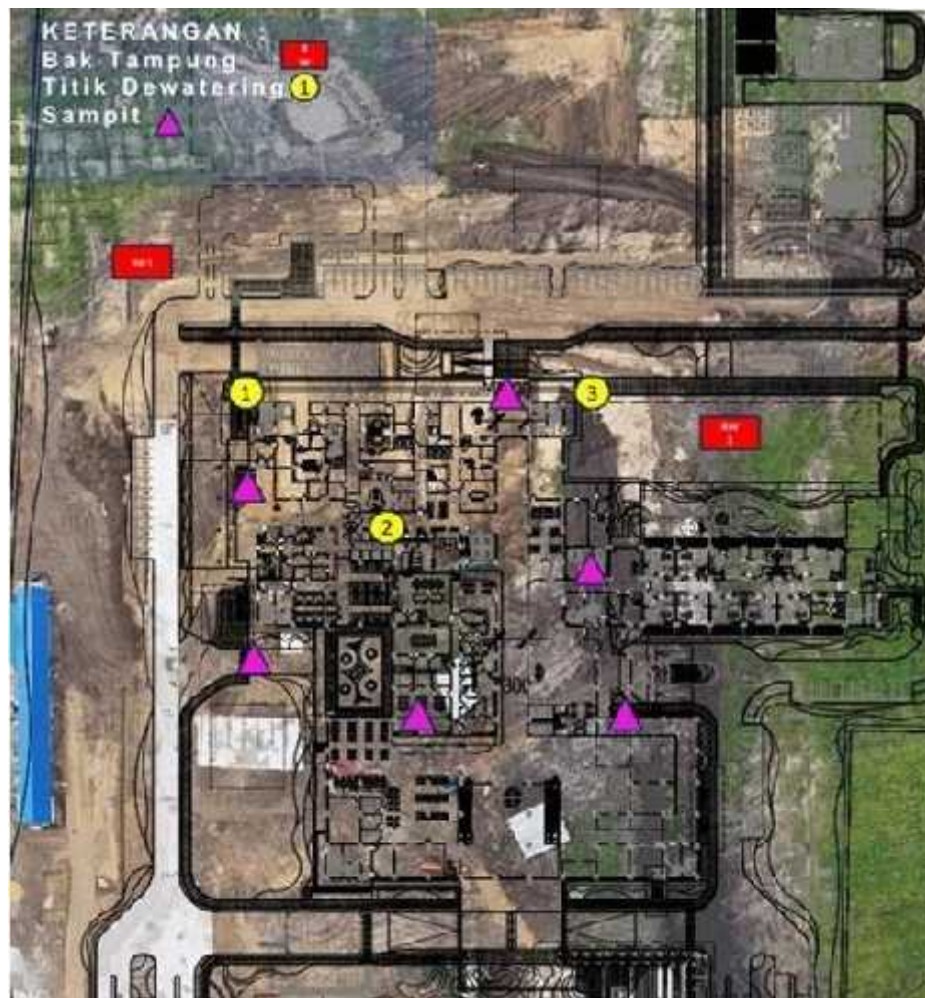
11:Tampak Atas Konstruksi Fisik Dan Bangunan Pembangunan Rumah Sakit Upt Vertikal Riau
